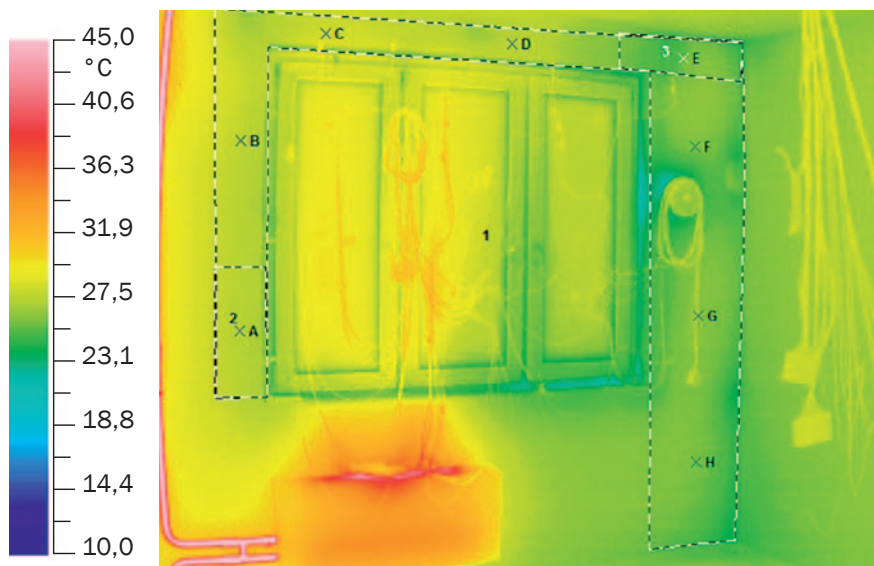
Стена со светопроемом с датчиками теплового потока и температуры. Комната в осях 7–8, Г–Е на четвертом этаже. Красным контуром выделена наиболее теплопроводная зона, синим – наименее теплопроводная
